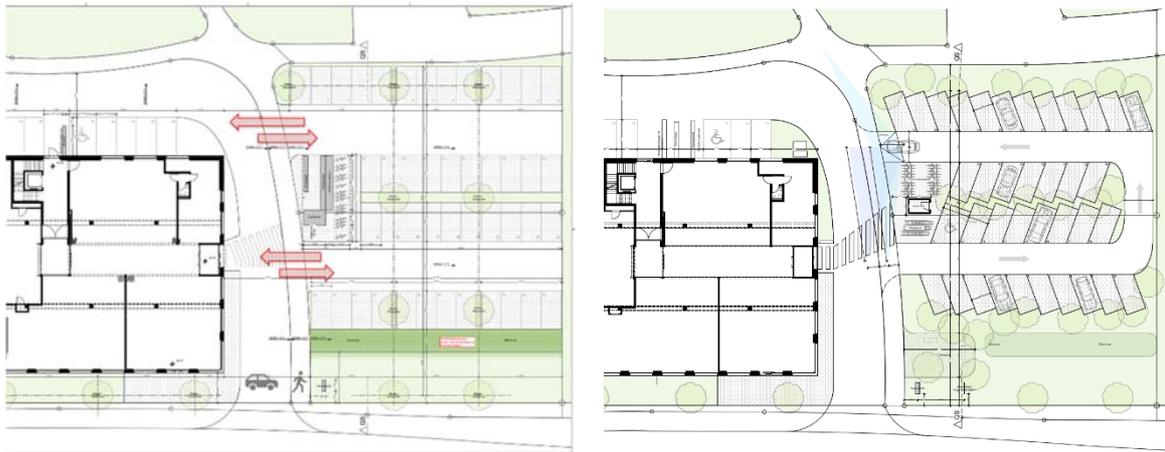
Entwurf Umgebungsplan Projekt (links); neuer Umgebungsplan Projekt Essane Center (rechts, Stand: 10.02.2023)
